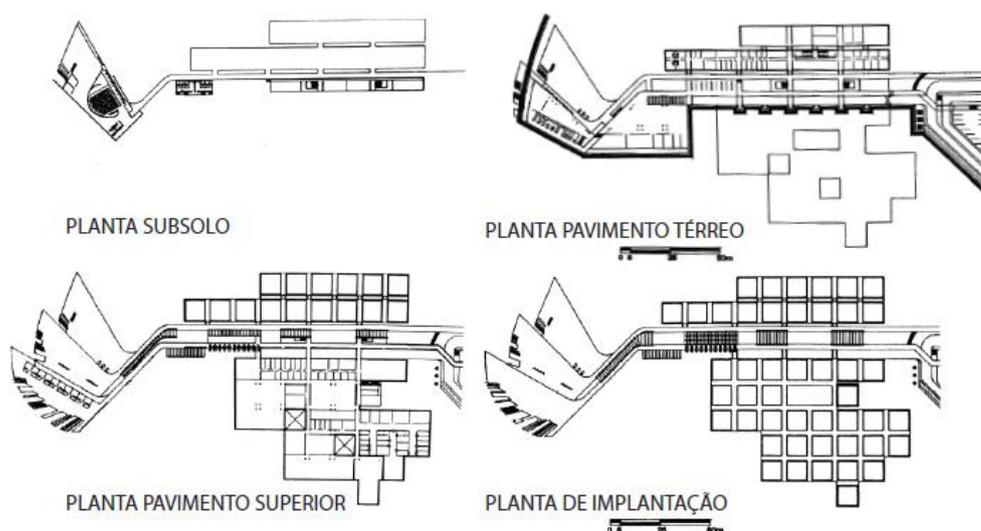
Terrafoto: plantas do subsolo, térreo, pavimento superior e de implantação.
